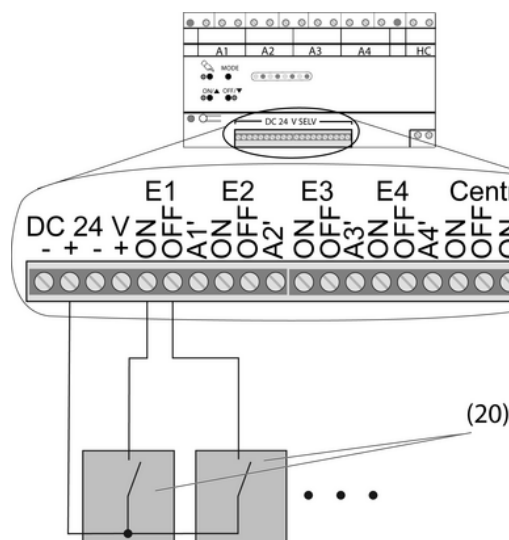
Anschlussbeispiel unbeleuchtete Installationstaster
